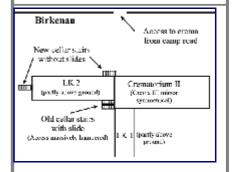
Ubicación esquemática del crematorio II, planta alterada. Para ajustarlo a la ubicación más alta de la morgue y el acceso en Birkenau desde el otro lado (espejo del crematorio III).
